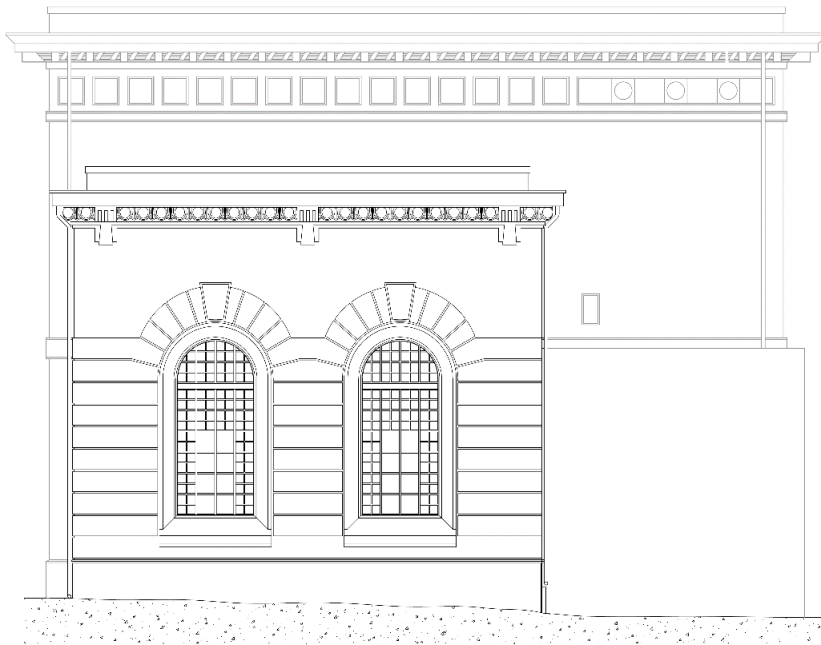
Ridisegno, non in scala, del prospetto ovest, centrale di San Floriano (1919).
